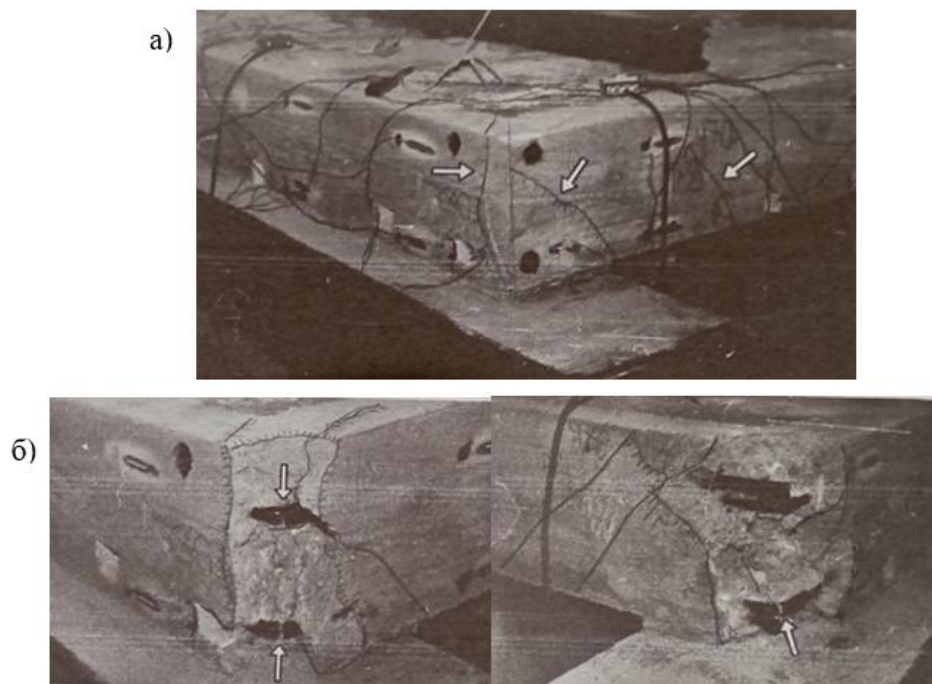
Разрушение фрагмента ФП. Разрыв нижних и верхних гнутых стержней в углах обвязочной рамы (места разрыва обозначены стрелками): а – характер трещинообразования в бруске рамы; б – угол с разрывом верхнего и нижнего стержней с выколом бетона
